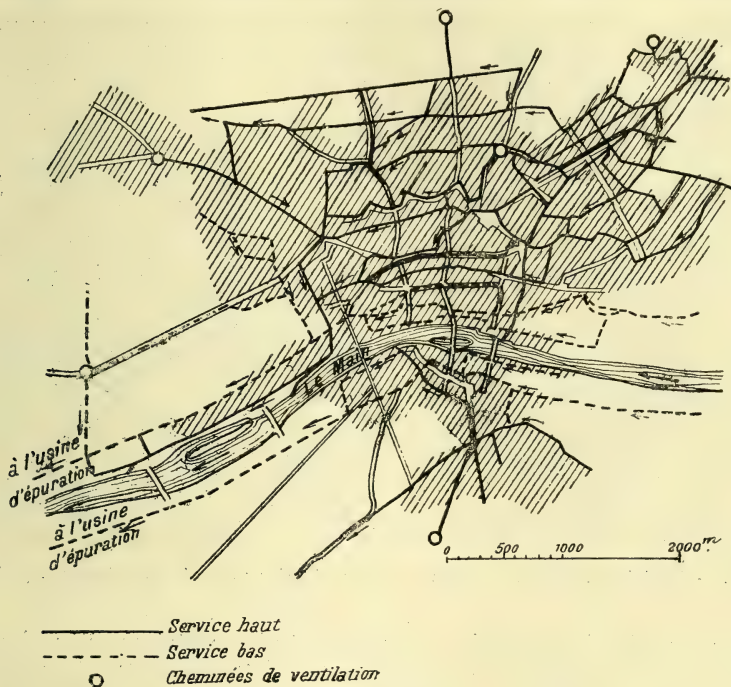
Les égouts de Francfort-sur-le-Mein. — Plan des collecteurs (syst. parallèle). (Imbeaux.)
